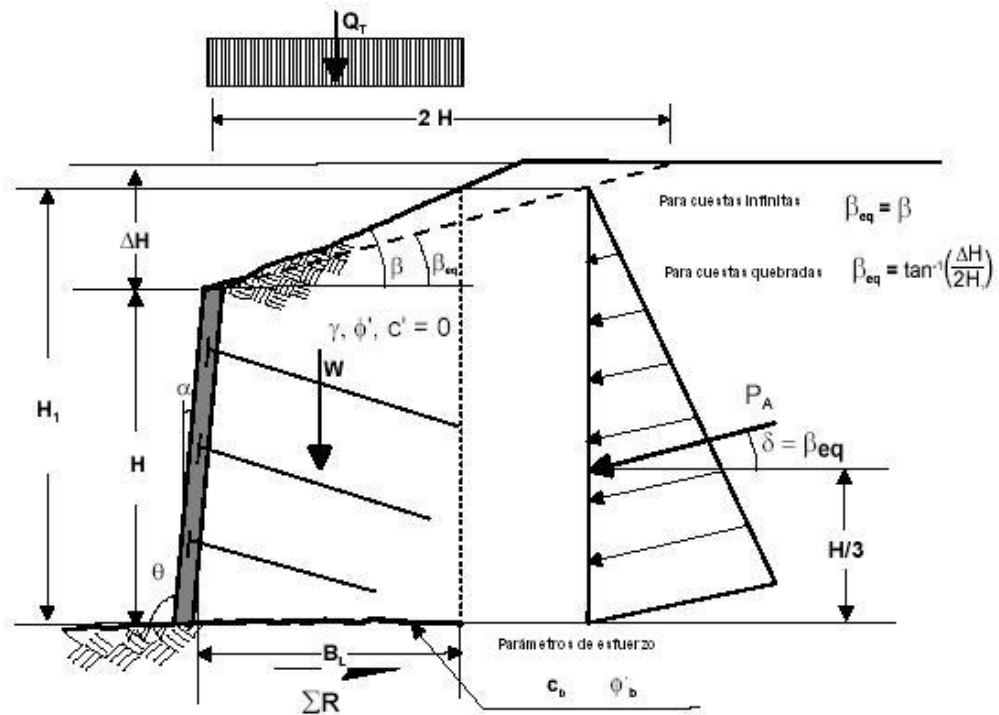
Estabilidad por deslizamiento de un muro de soil nailing.
